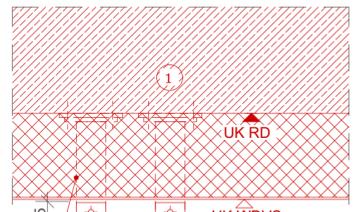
Fusspunkte Horizontalschnitt, M 1:10
